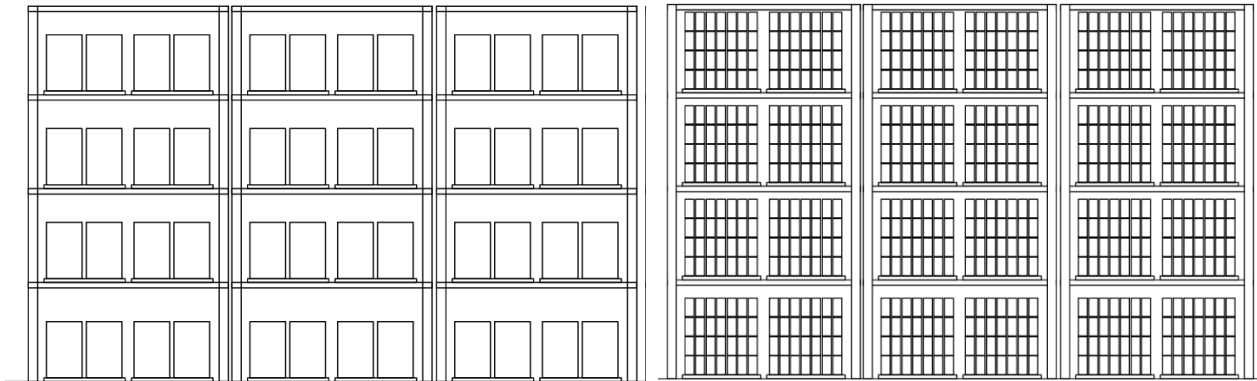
Diseño vista frontal de la línea de producción de diluyente
